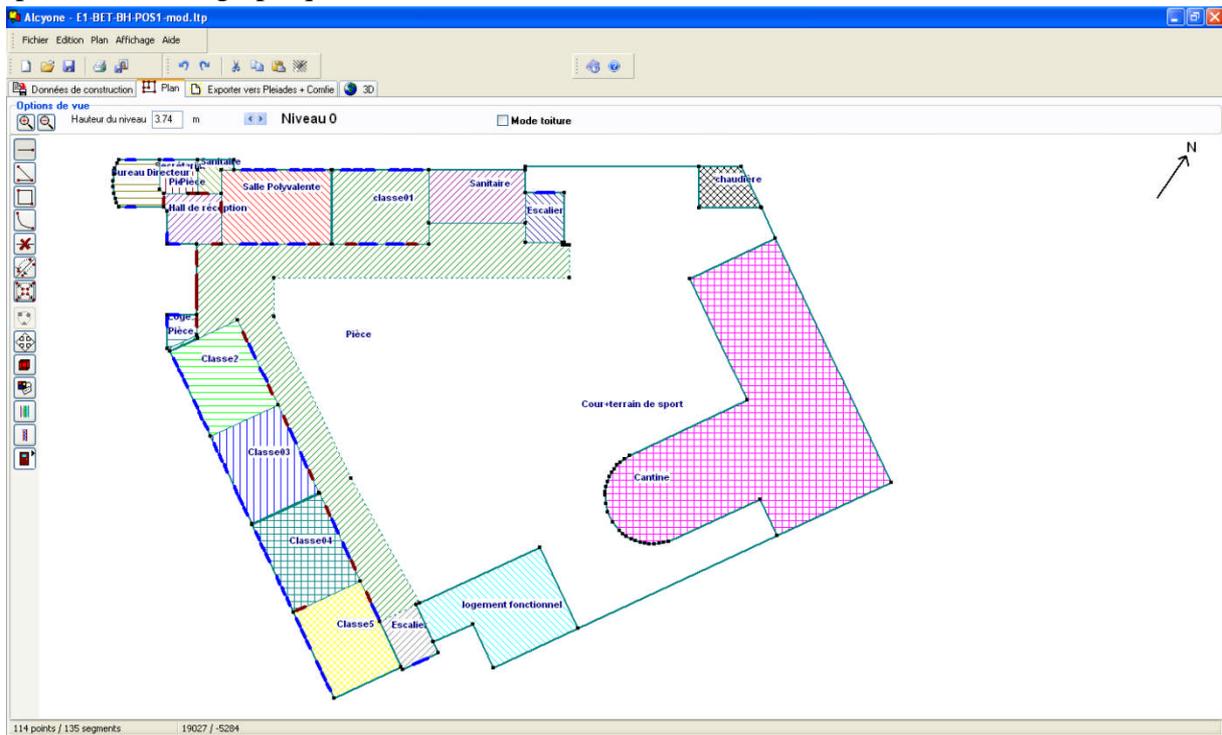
Plan du rez-de-chaussée de E1-D1-BH
